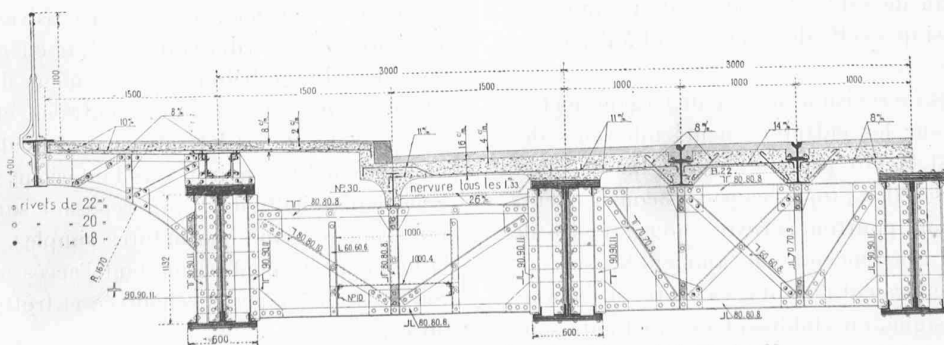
Demi-coupe transversale à la clef. — Echelle 1 : 60.
